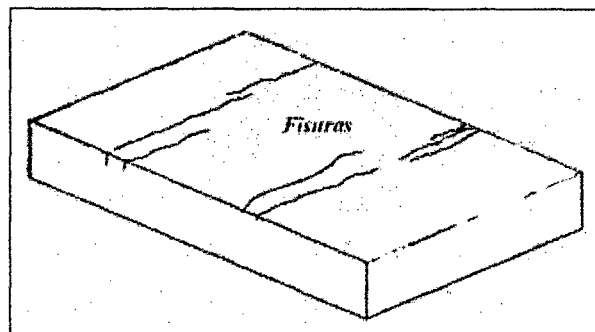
18. Fisuración longitudinal siguiendo la dirección de las vigas debido a la retracción hidráulica del concreto. Fuente: (Stuardo P., 2008)
